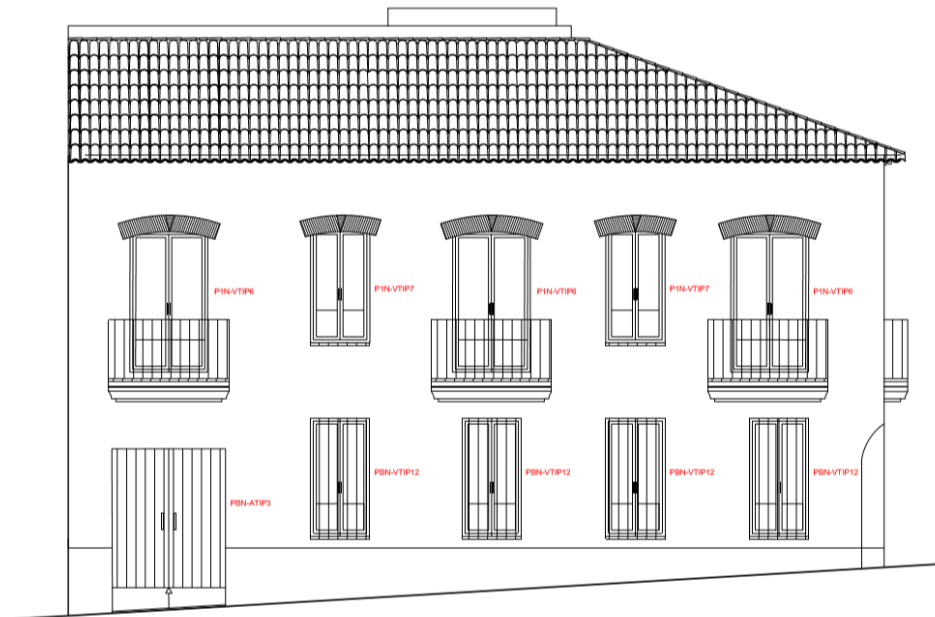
Alzado norte. Fuente: Elaboración propia, creación 27/06/2019
